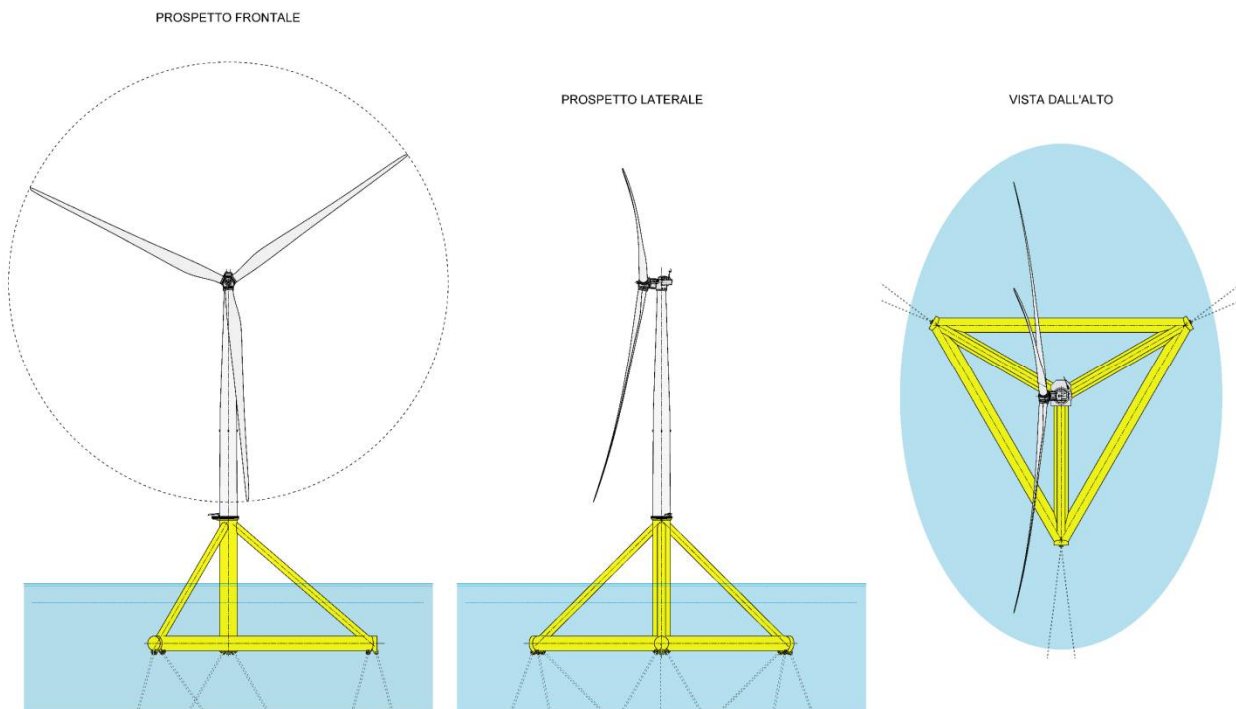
Esempio di fondazione per aerogeneratore galleggiante.
